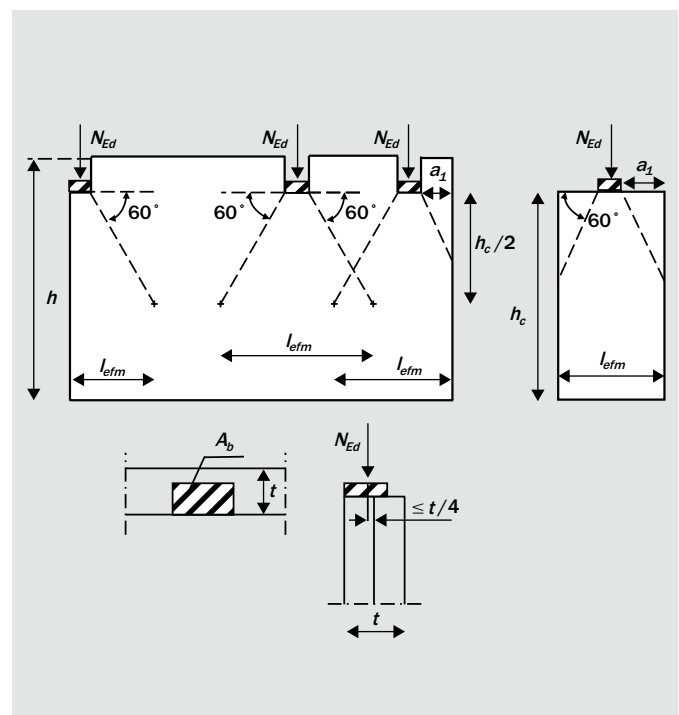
Wände unter Teilflächenlasten nach DIN EN 1996-1-1
